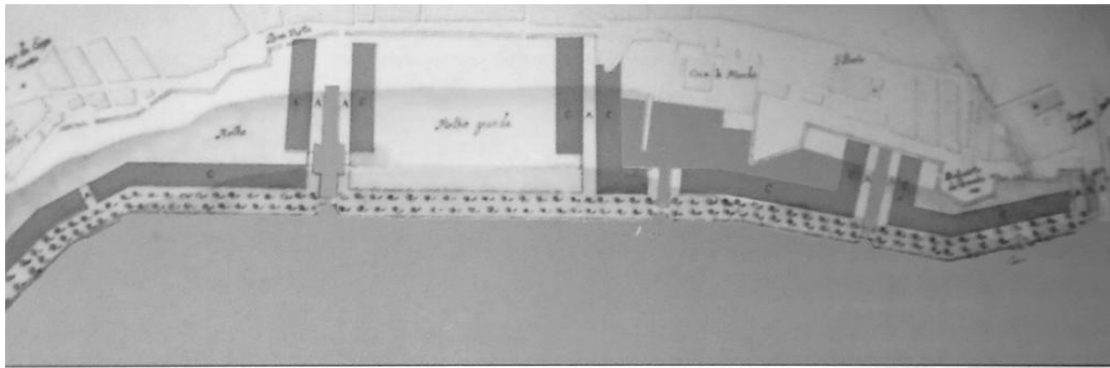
| Pormenor da Planta (1733-63) de Carlos Mardel, in (GARCIA, 2009)
